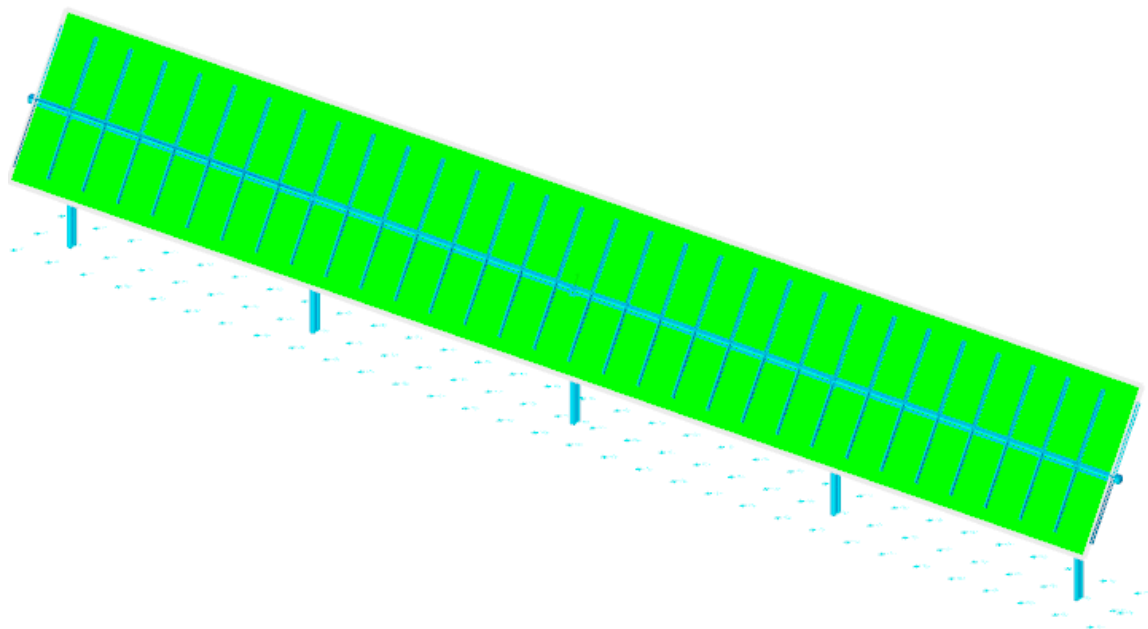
Vista assonometrica modello strutturale con posizione della “vela” inclinata di 60°
